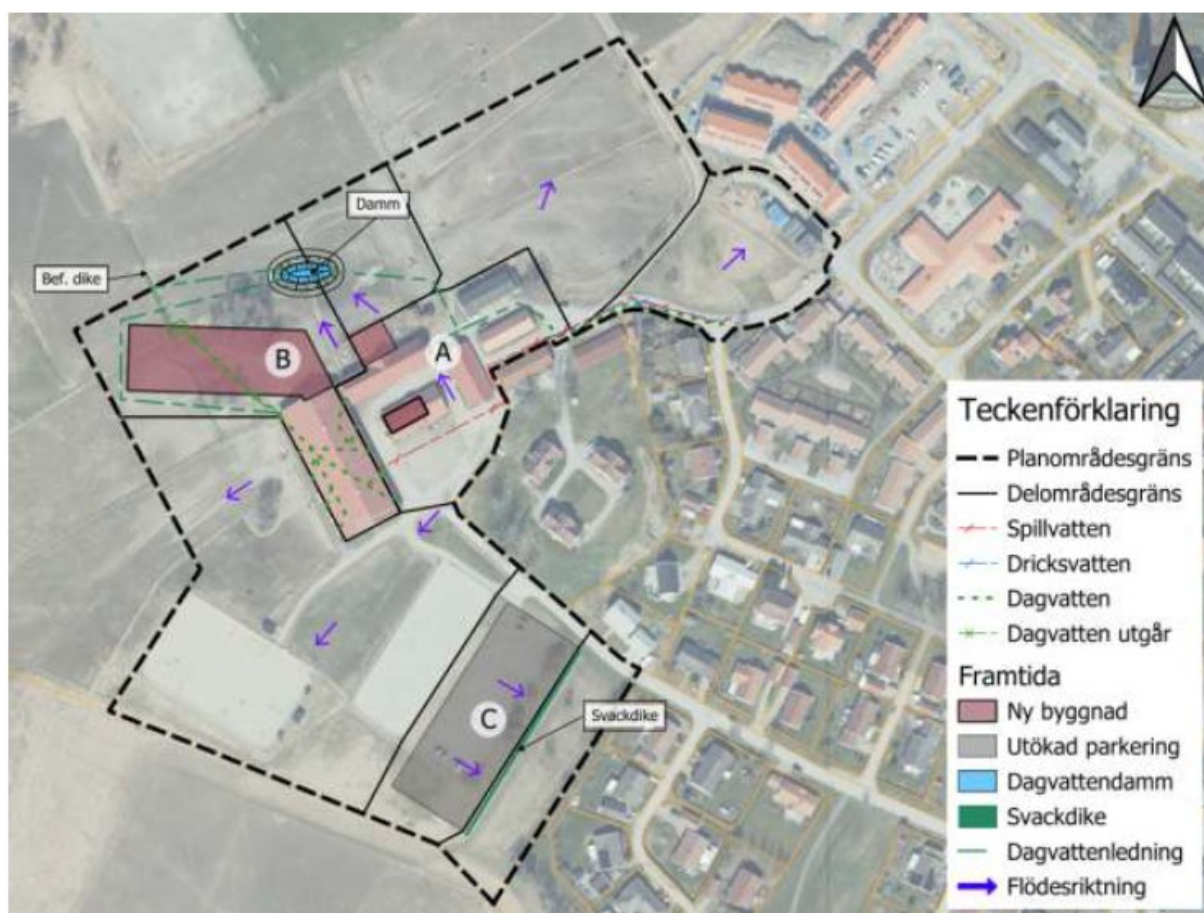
Föreslagen placering av dagvattendamm, dammen måste inte placeras exakt enligt förslaget.
